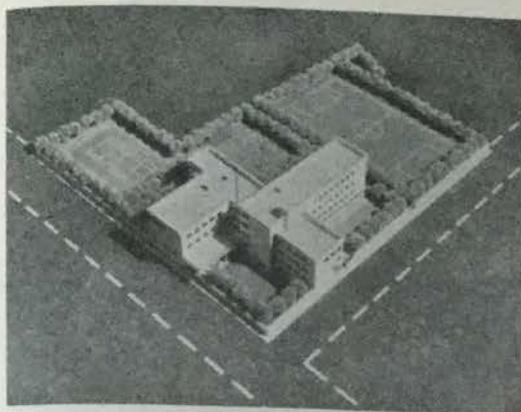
Convitto Biellese - II progetto: vista del plastico.
